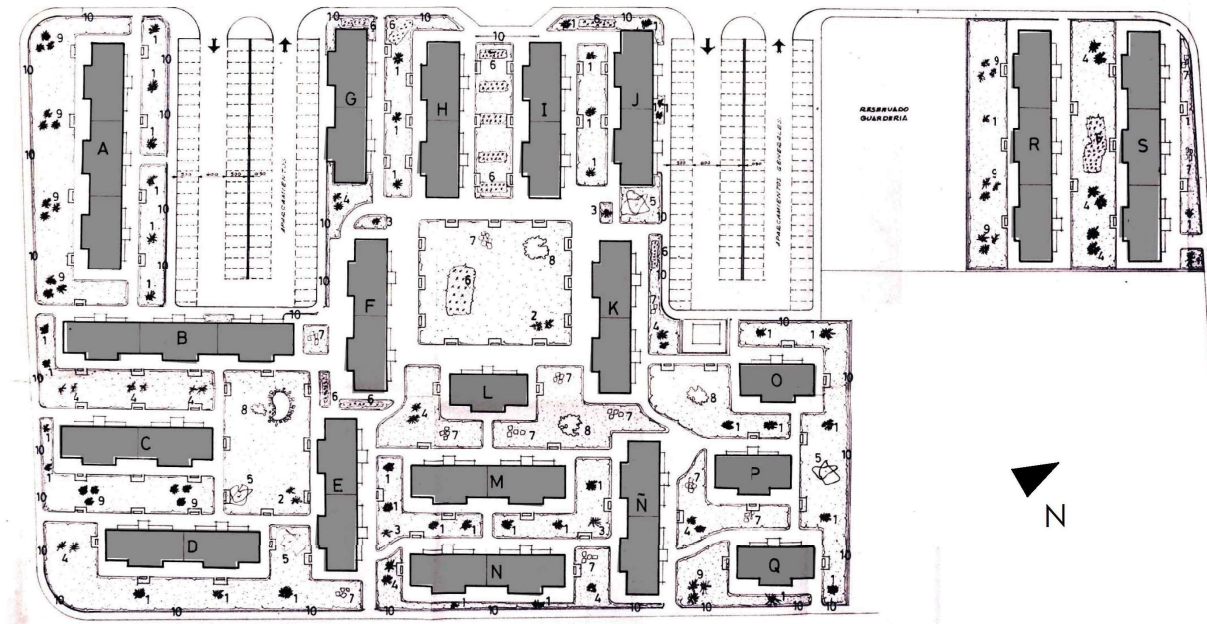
Plano de urbanización en planta perteneciente al proyecto original.
